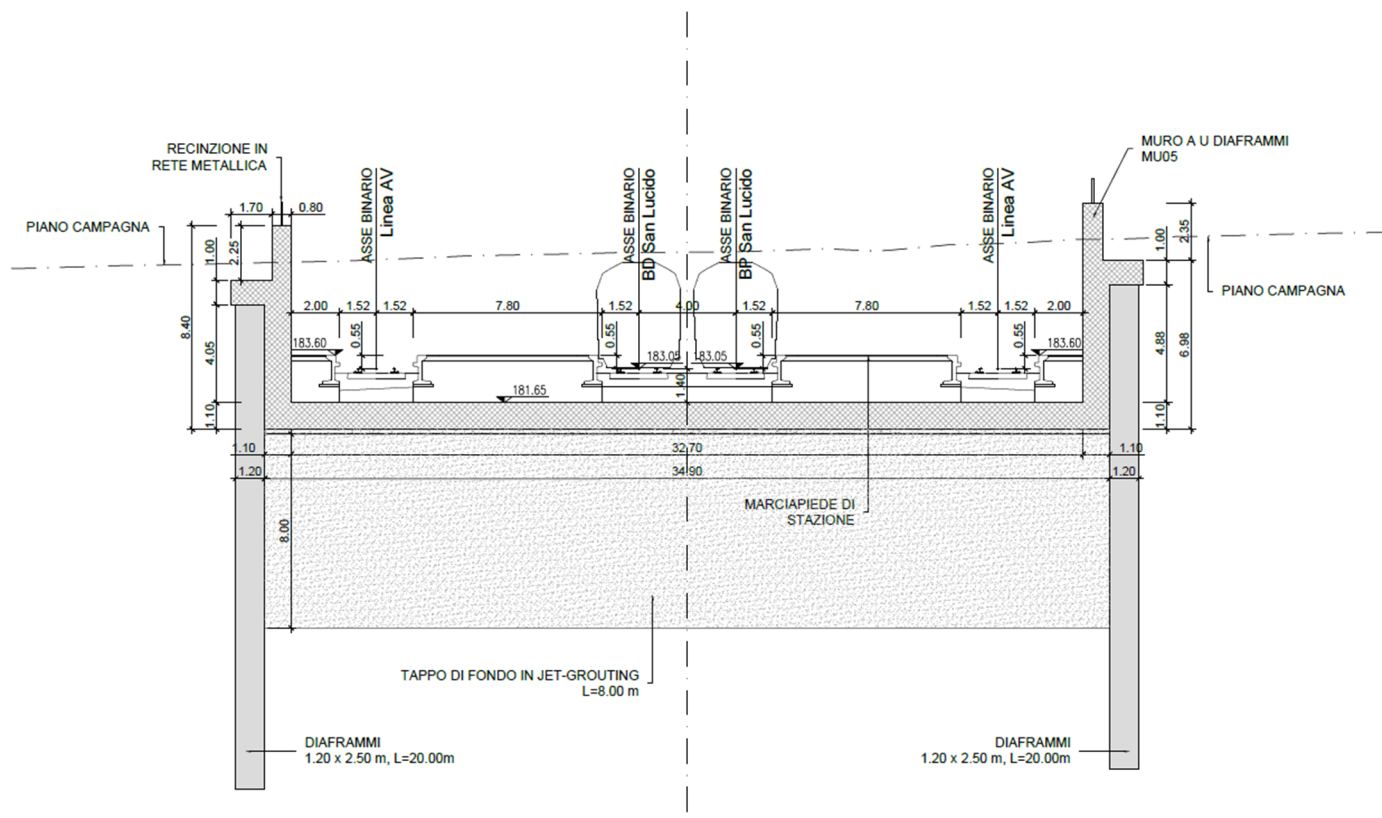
Sezioni Tipo Muro a U tra diaframmi Tipo 1
